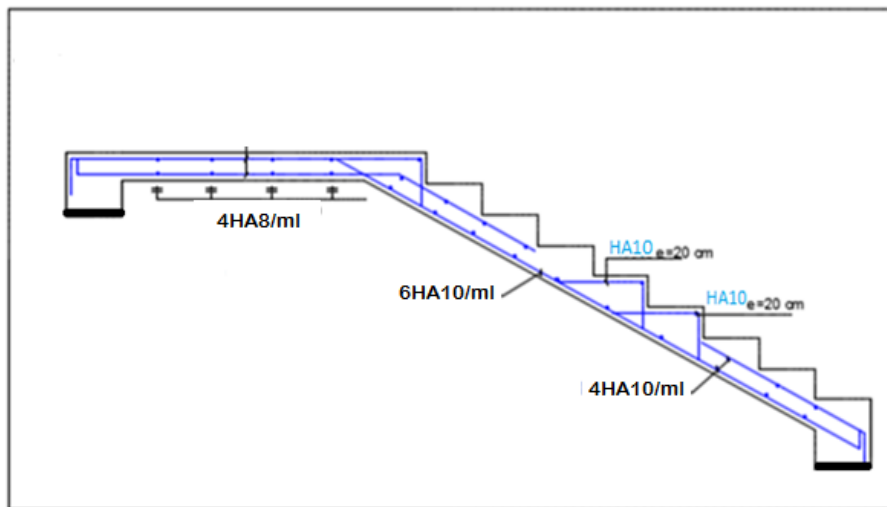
Schéma de ferrailage des escaliers à paillasse adjacentes.
